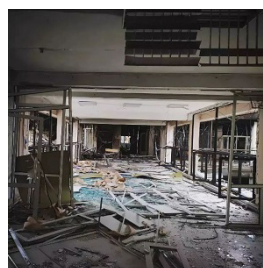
Корпус № 5 після бойових дій (вид зсередини)
